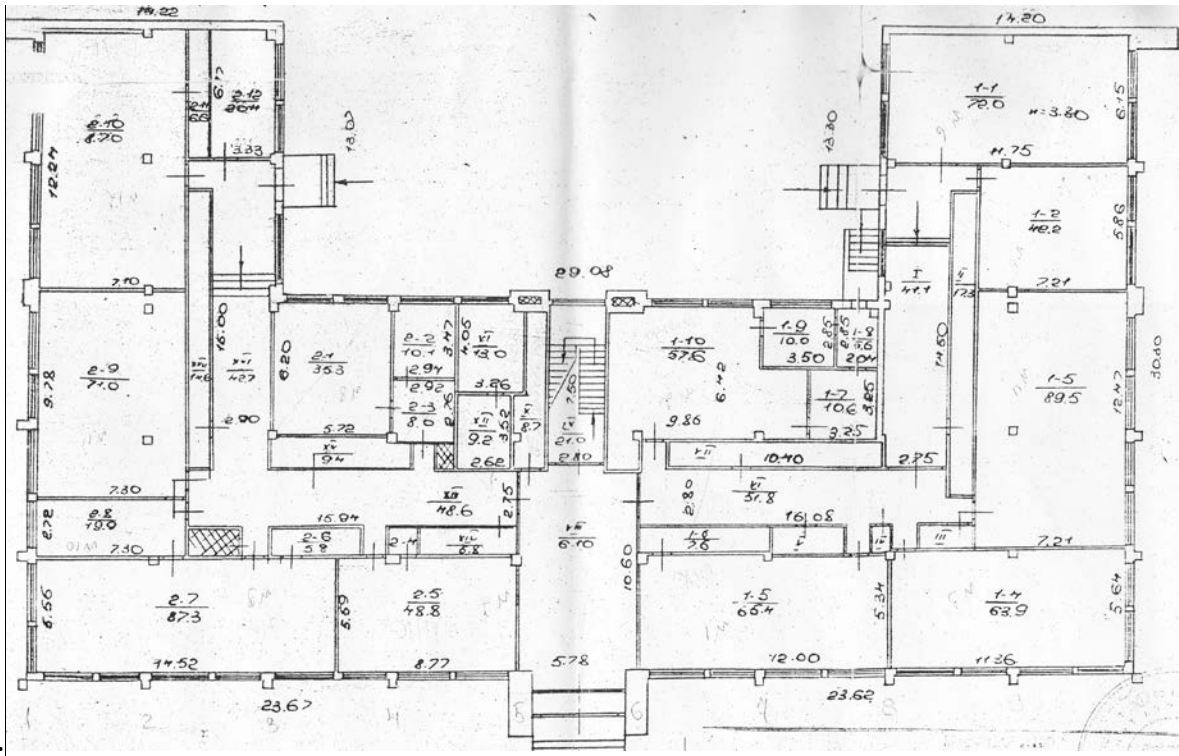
Схема розташування кімнат на 1-му поверху корпусу №7
